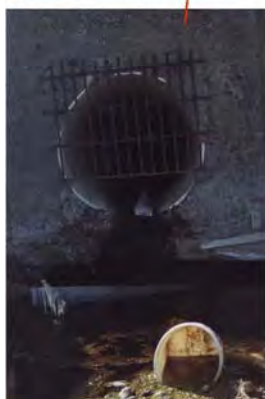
Detalle del punto 2 de la laguna 2 con viviendas en dicha margen.
